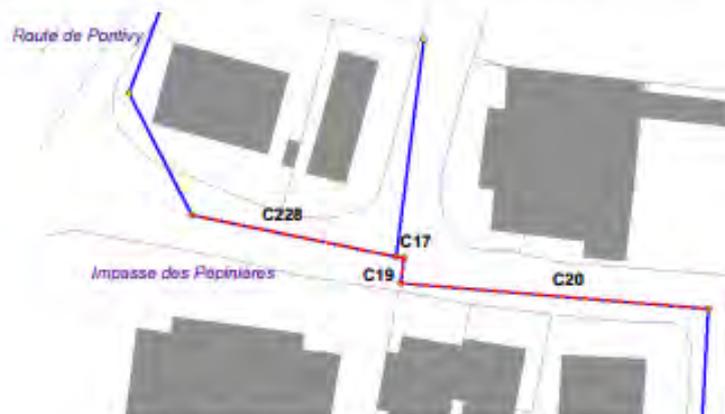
Renforcement proposé dans la zone d'activités de Kermestre
